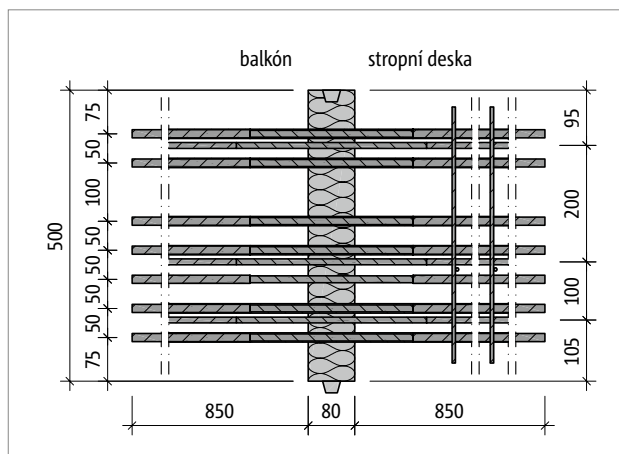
Schöck Isokorb® T typ KL-M4-VV1: Půdorys prvku
